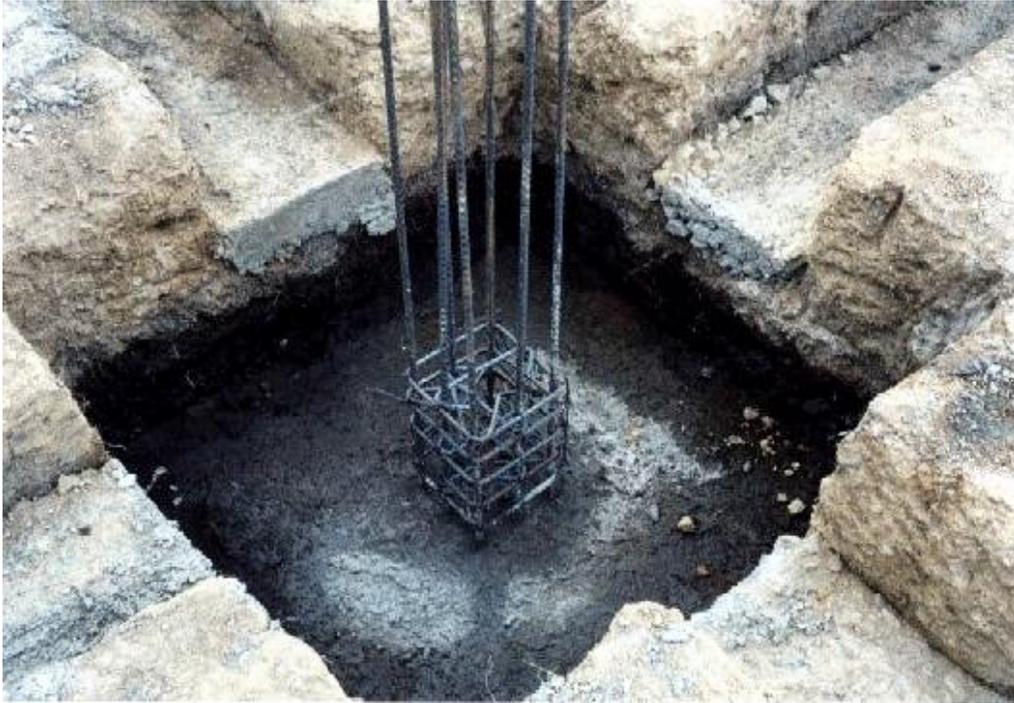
Excavaciones de zapatas y vigas de cimentación bloque de 1 piso
